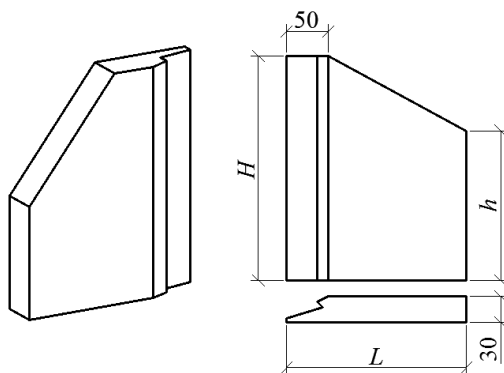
Откосная стенка для железобетонной безнапорной раструбной трубы
